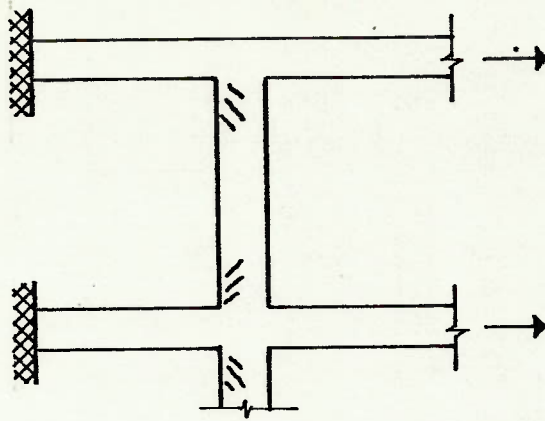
Pilar fissurado devido à movimentação térmica das vigas de concreto armado
